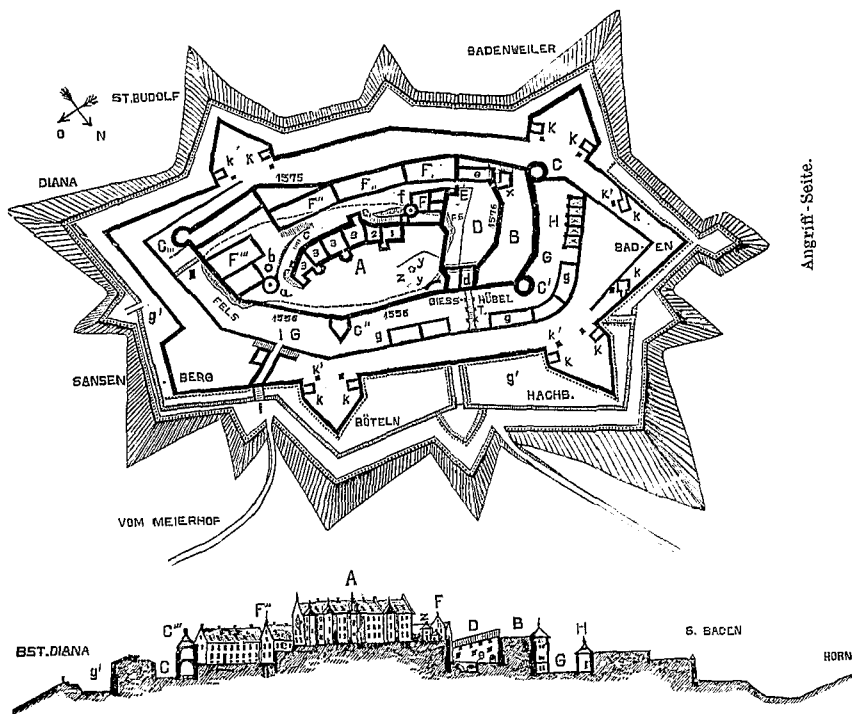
u. 73. Lageplan und Längenschnitt der Festung Hachberg 1:3000.
